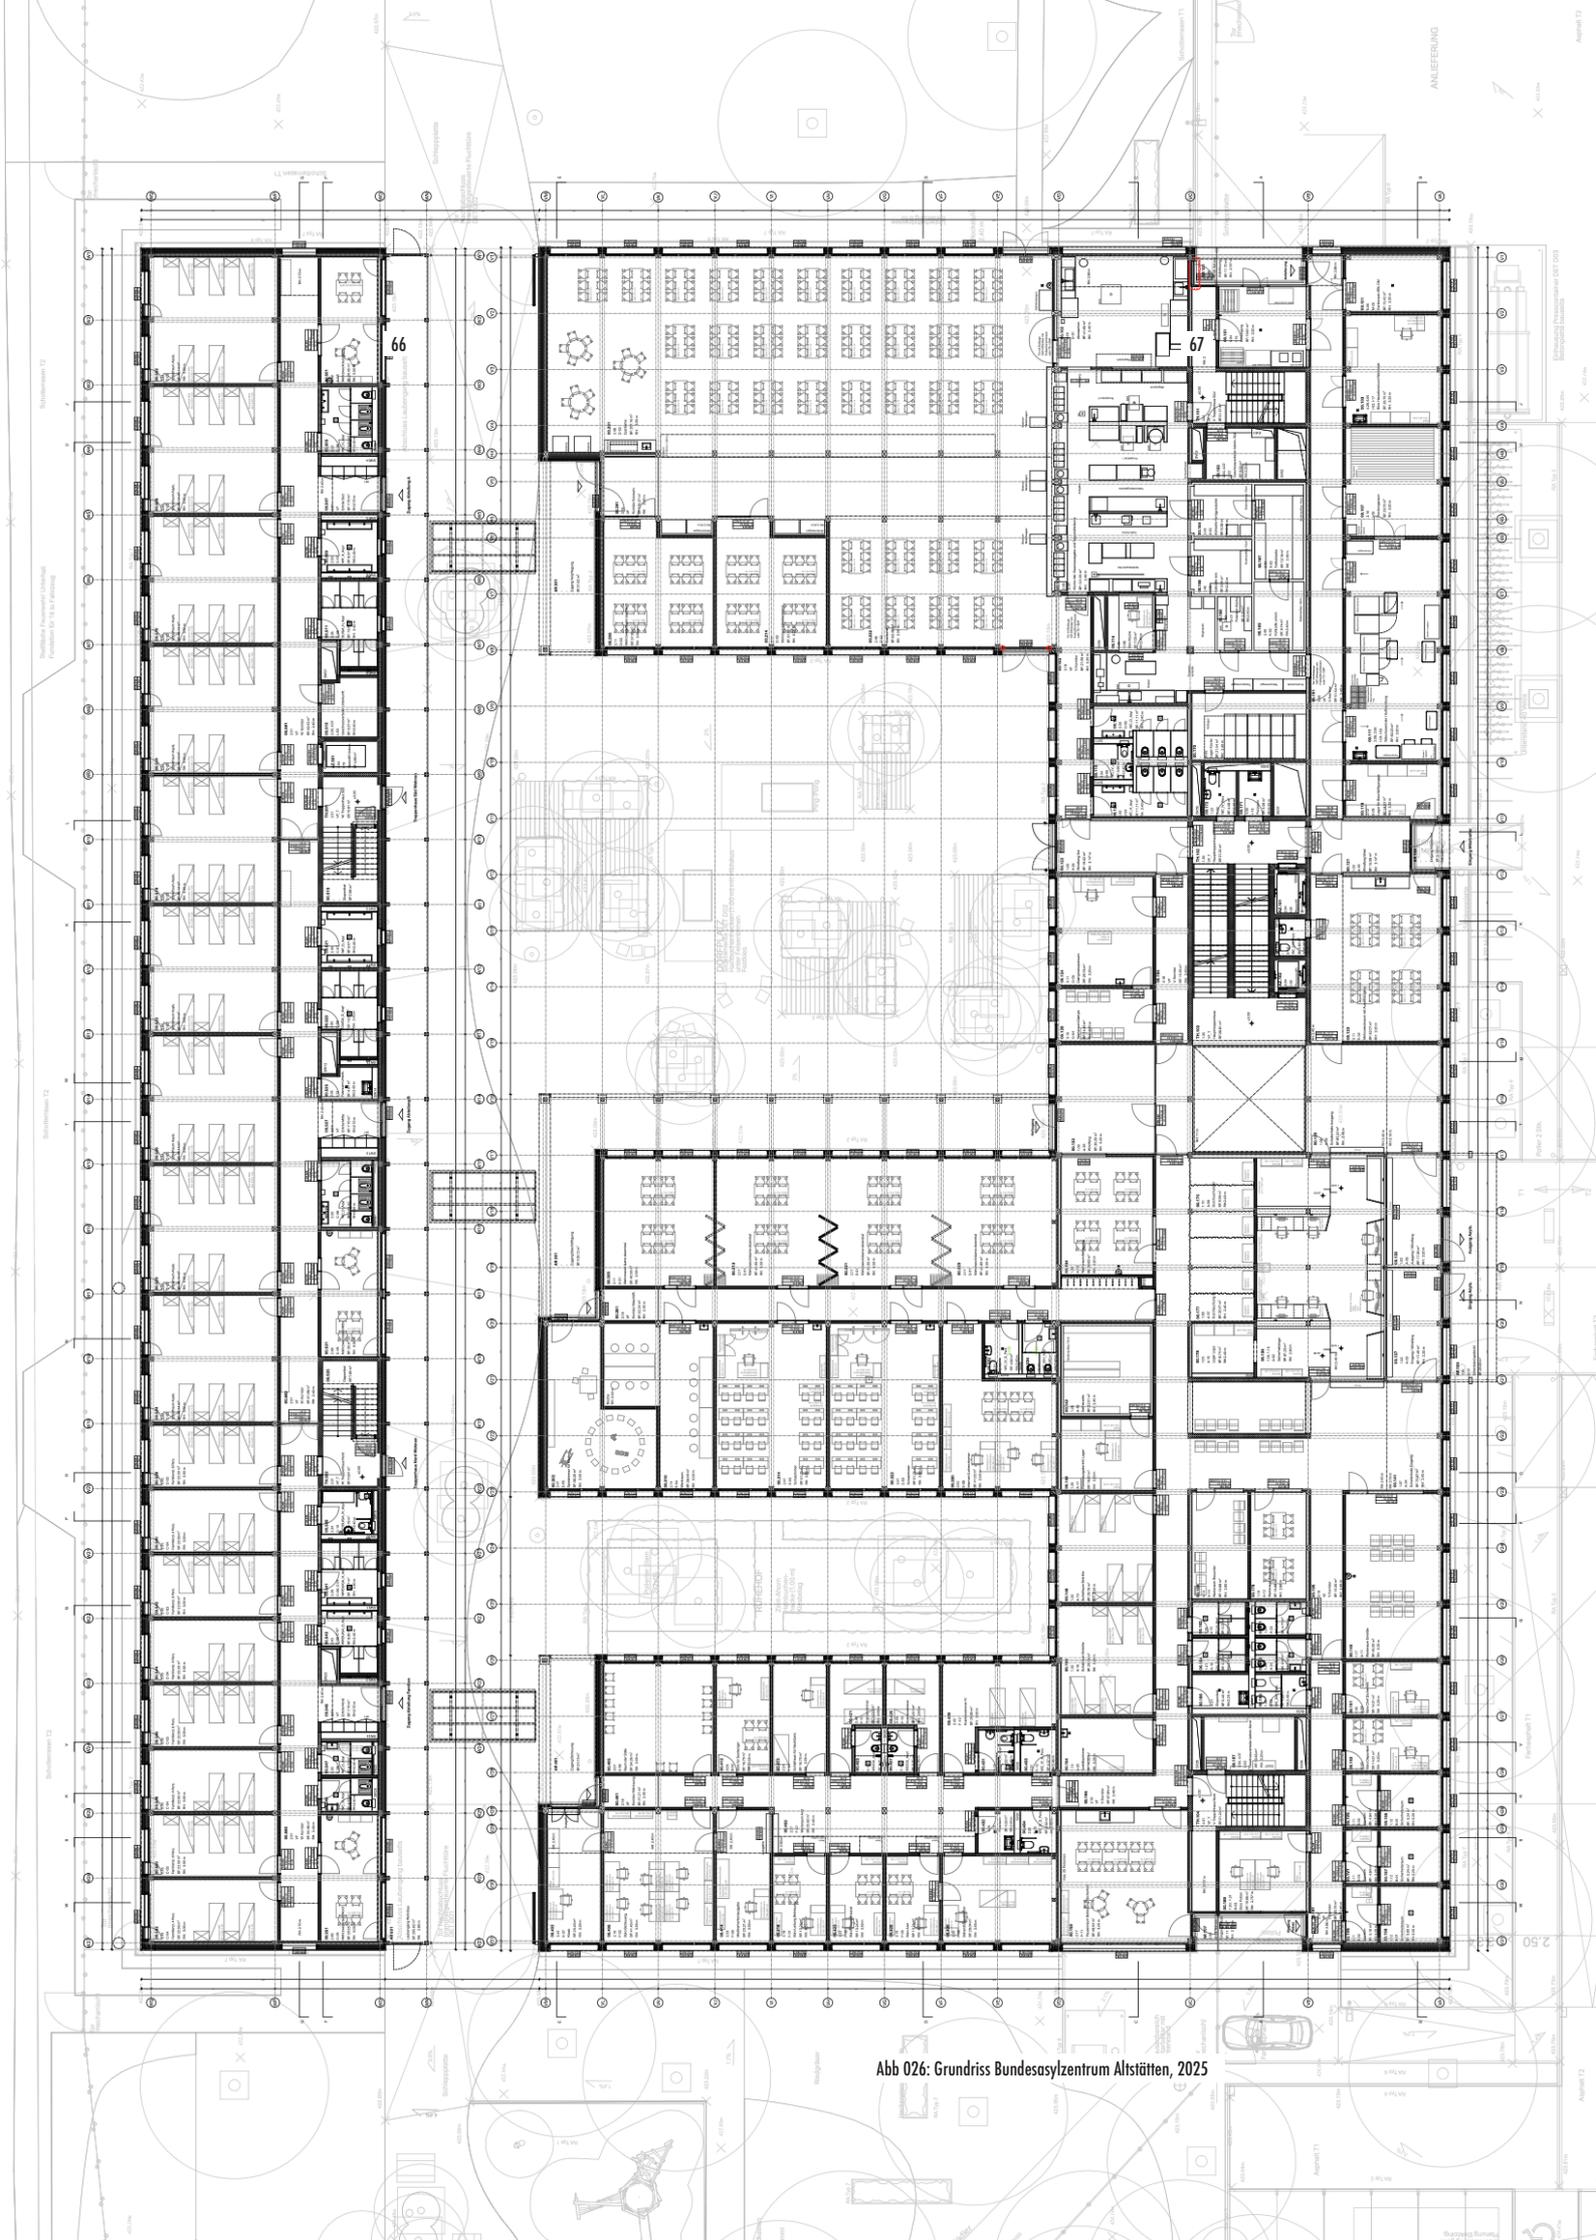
Grundriss Bundesasylzentrum Altstätten, 2025
